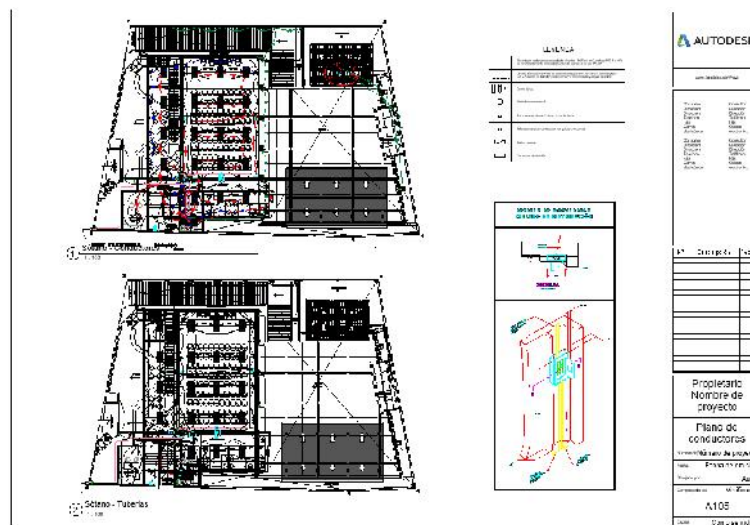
Plano planta sótano - Cableado y tubería. Fuente: Autor.
